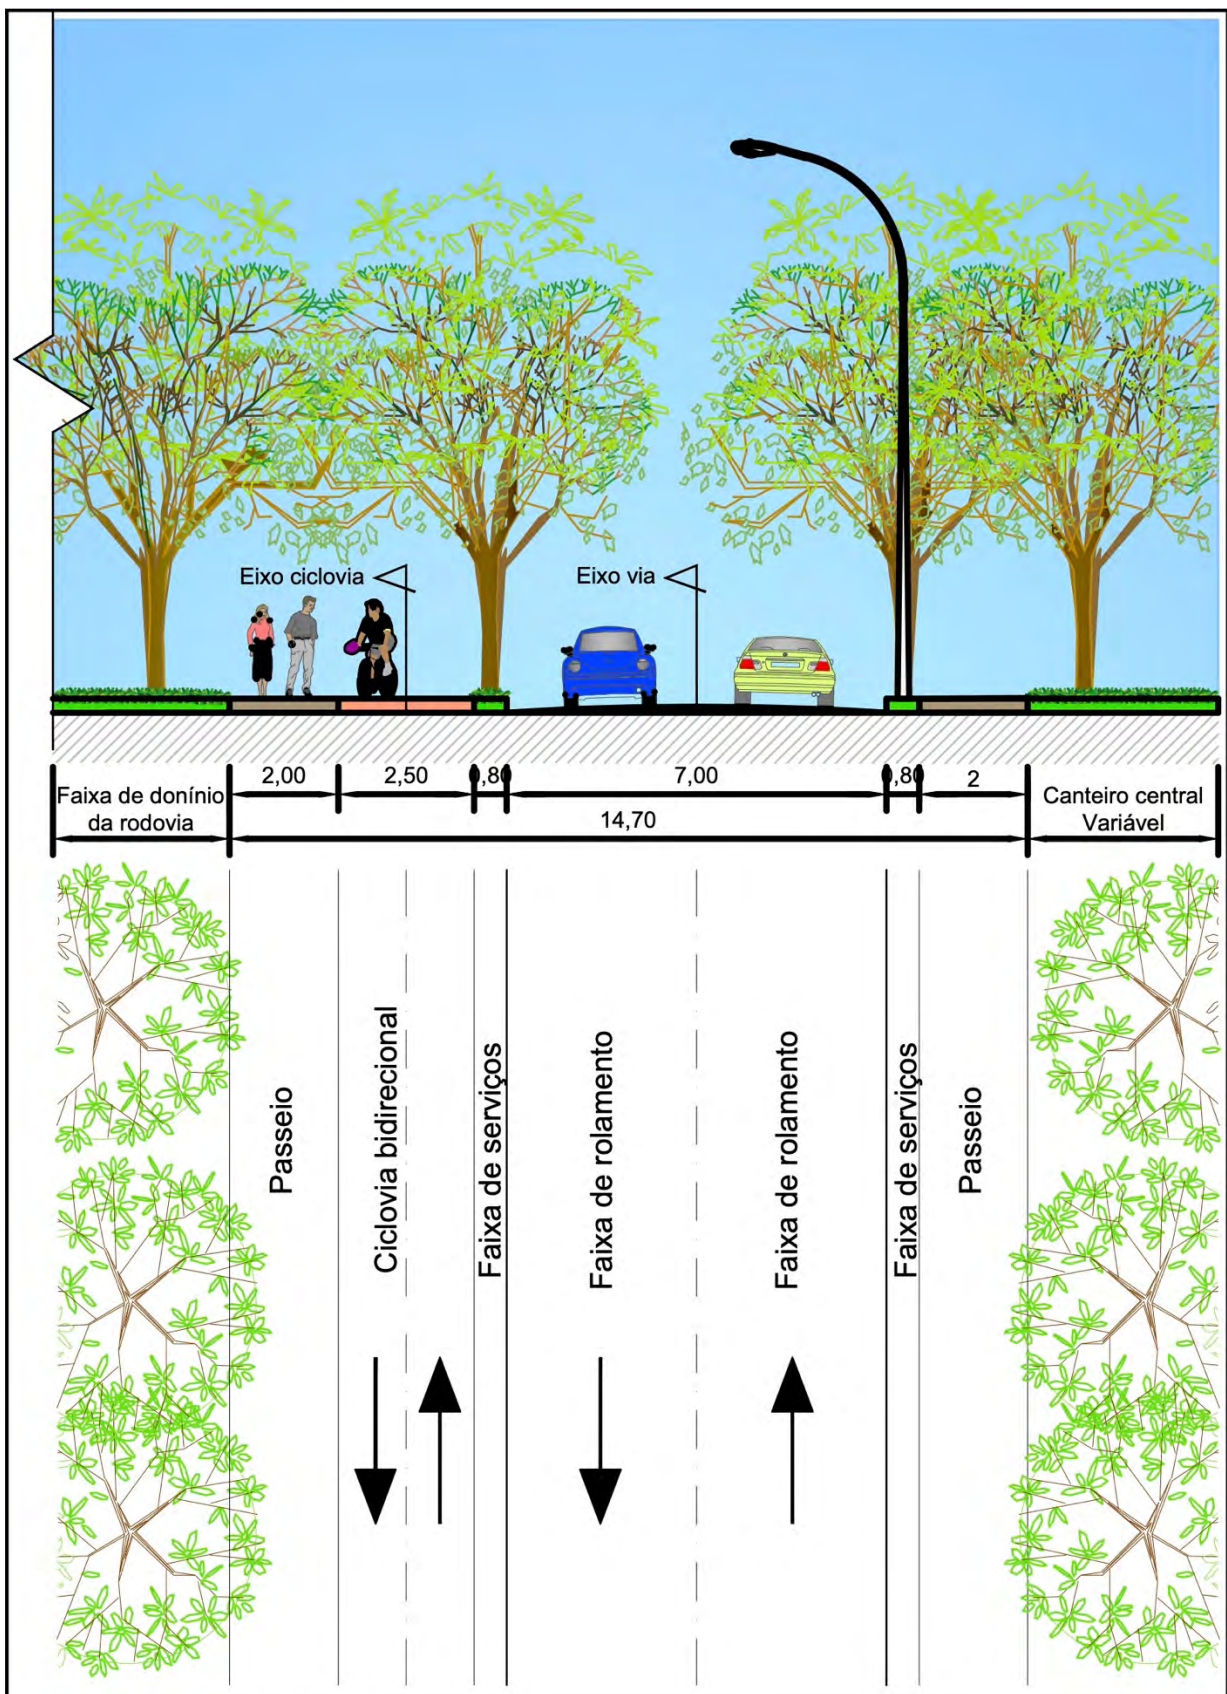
Perfil 01 - Via de circulação de vizinhança – DIUPE 44/2022
